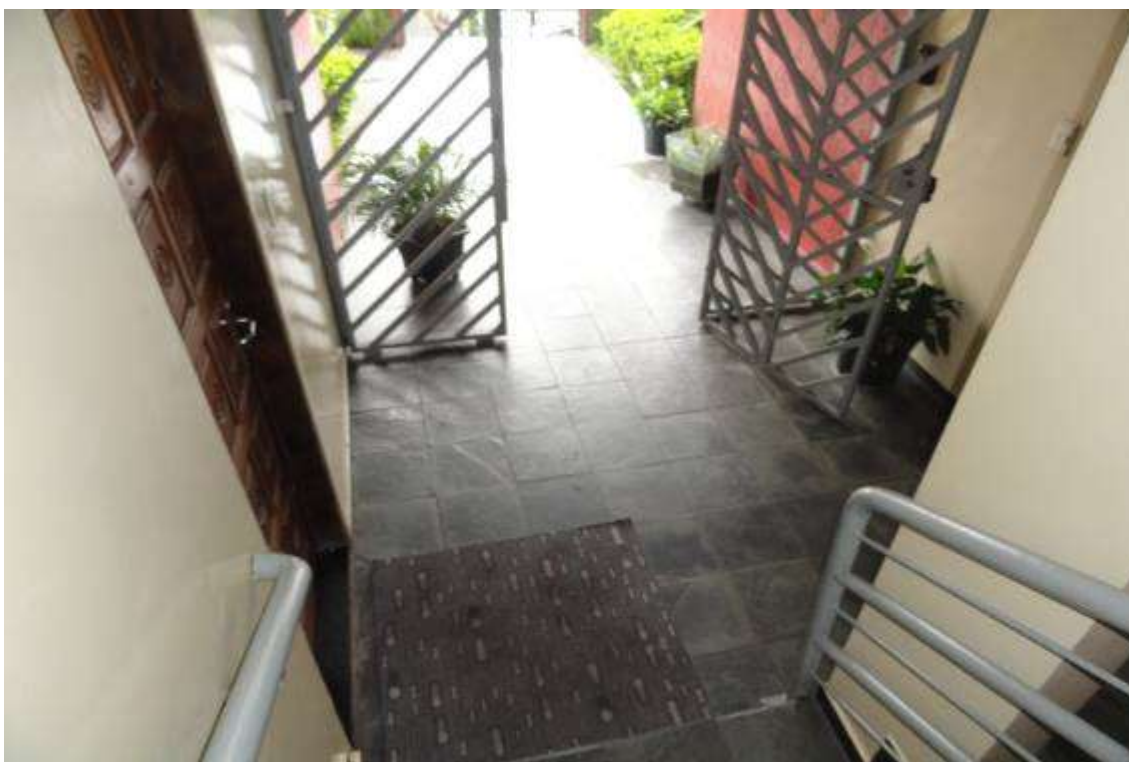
Vista do hall de entrada do bloco 01.
